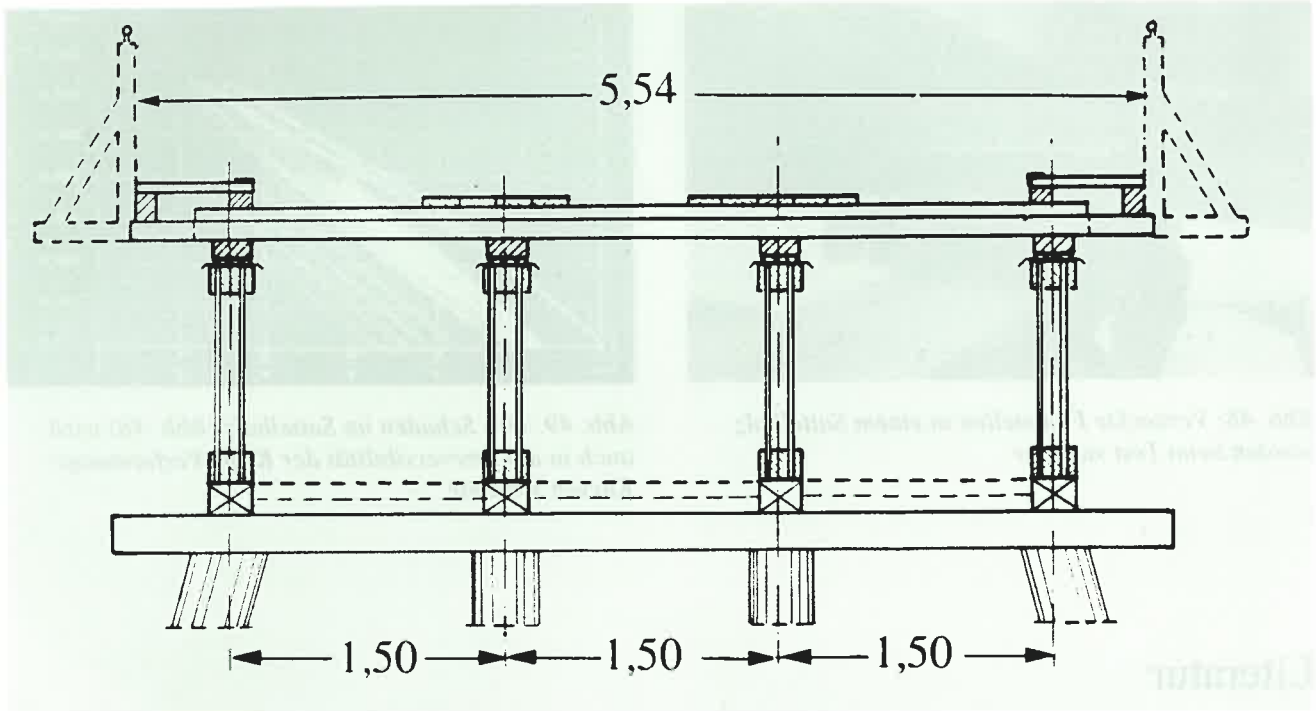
Querschnitt der Holzbrücke (19 Felder á 10,30 m)
